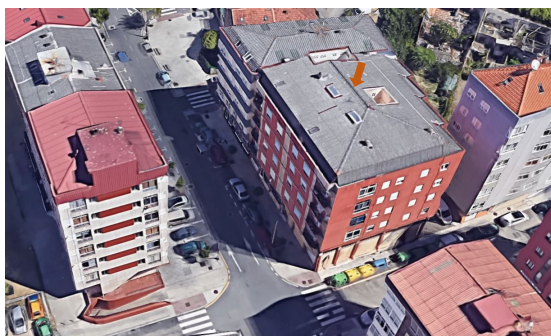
Vista aérea de las fachadas Sur y Oeste del edificio situado en la Rúa Eugenio Kraff, 11.
